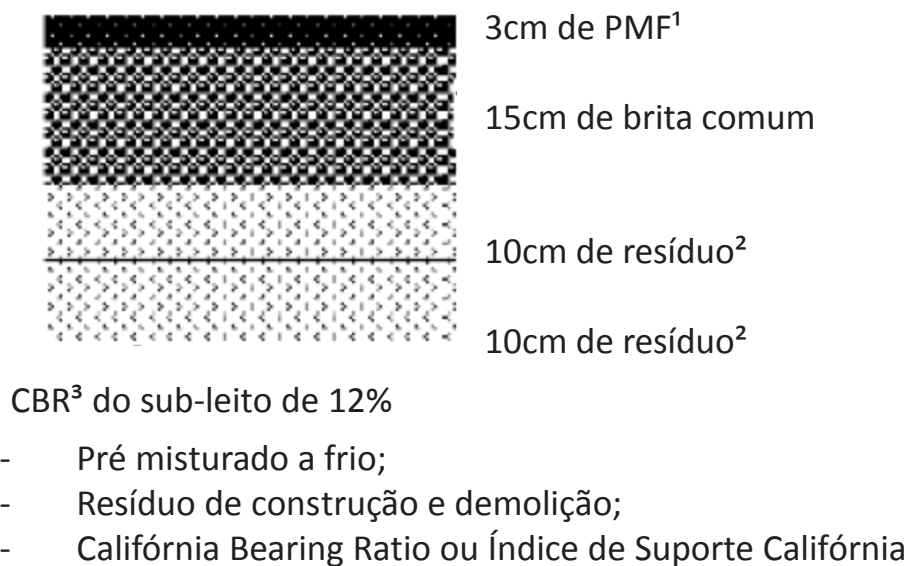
Esquema estrutural de pavimento com RCD (Fonte: MOTTA,2005)
